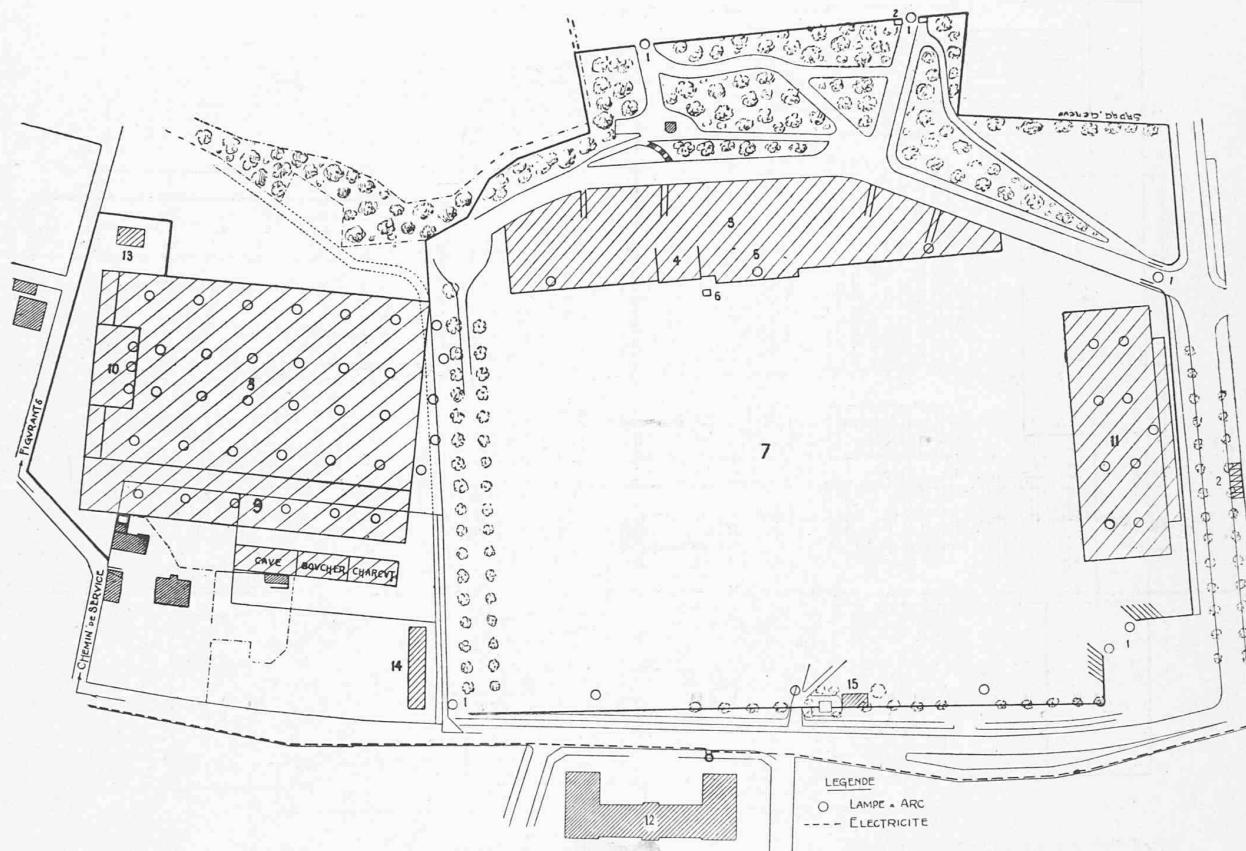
Plan général des constructions. — Echelle : 1 : 2500.
